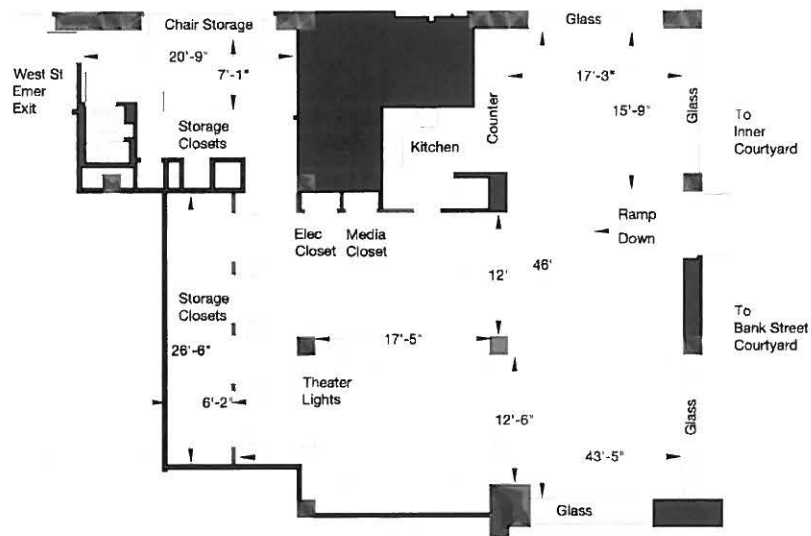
Planta de distribuição do *Wesbeth* – Casa das Artes
